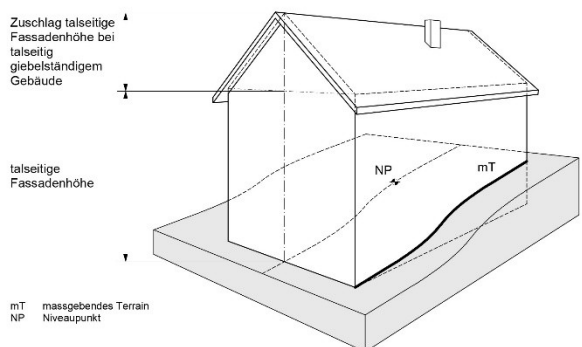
Fassadenhöhe gemäss Art. 86 PBG
